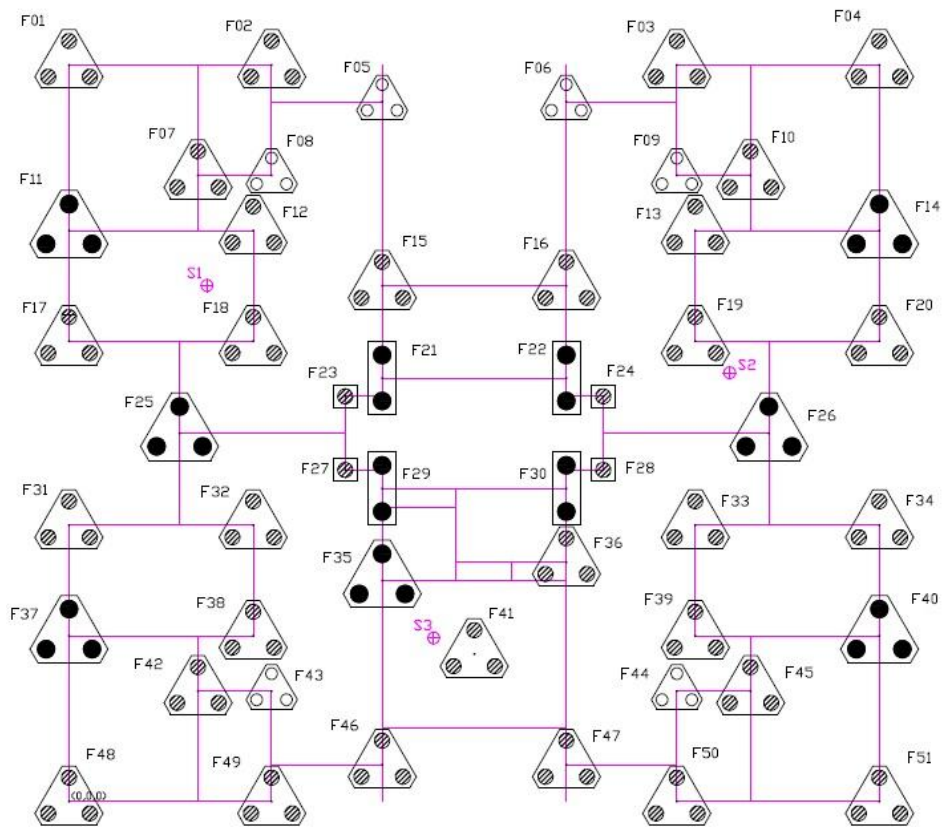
Planta de fundação profunda para o edifício quadrado.
